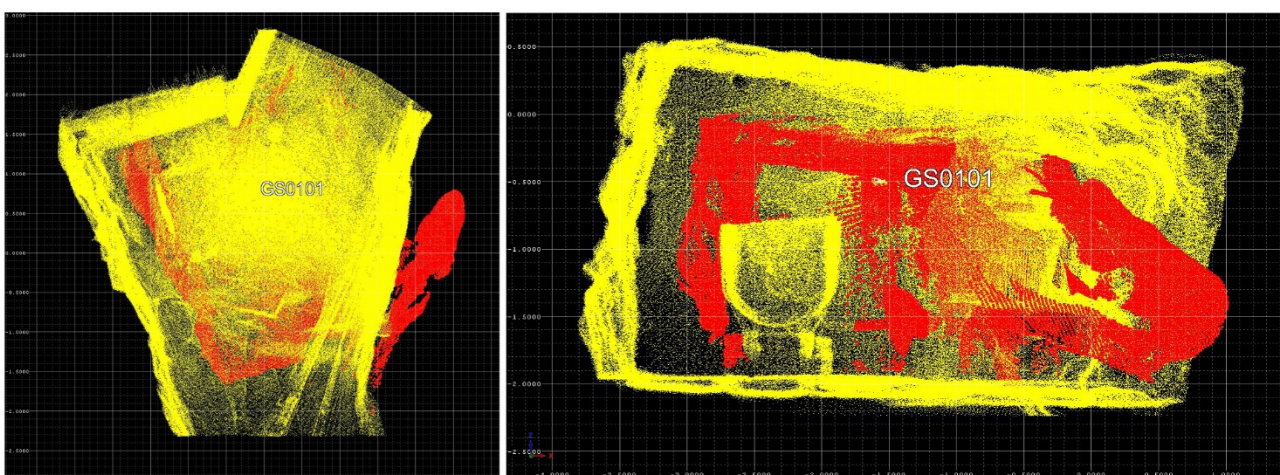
Ansicht einer fehlerhaften Punktwolke am Startpunkt GS0101 der dritten Schleife links im Grundriss und rechts im Schnitt
